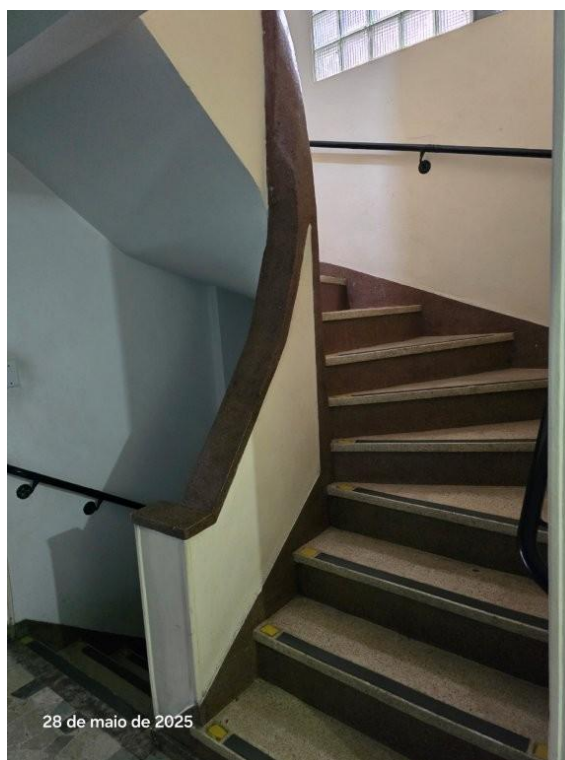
Vista geral das escadas de acesso ao Subsolo e pavimentos superiores
